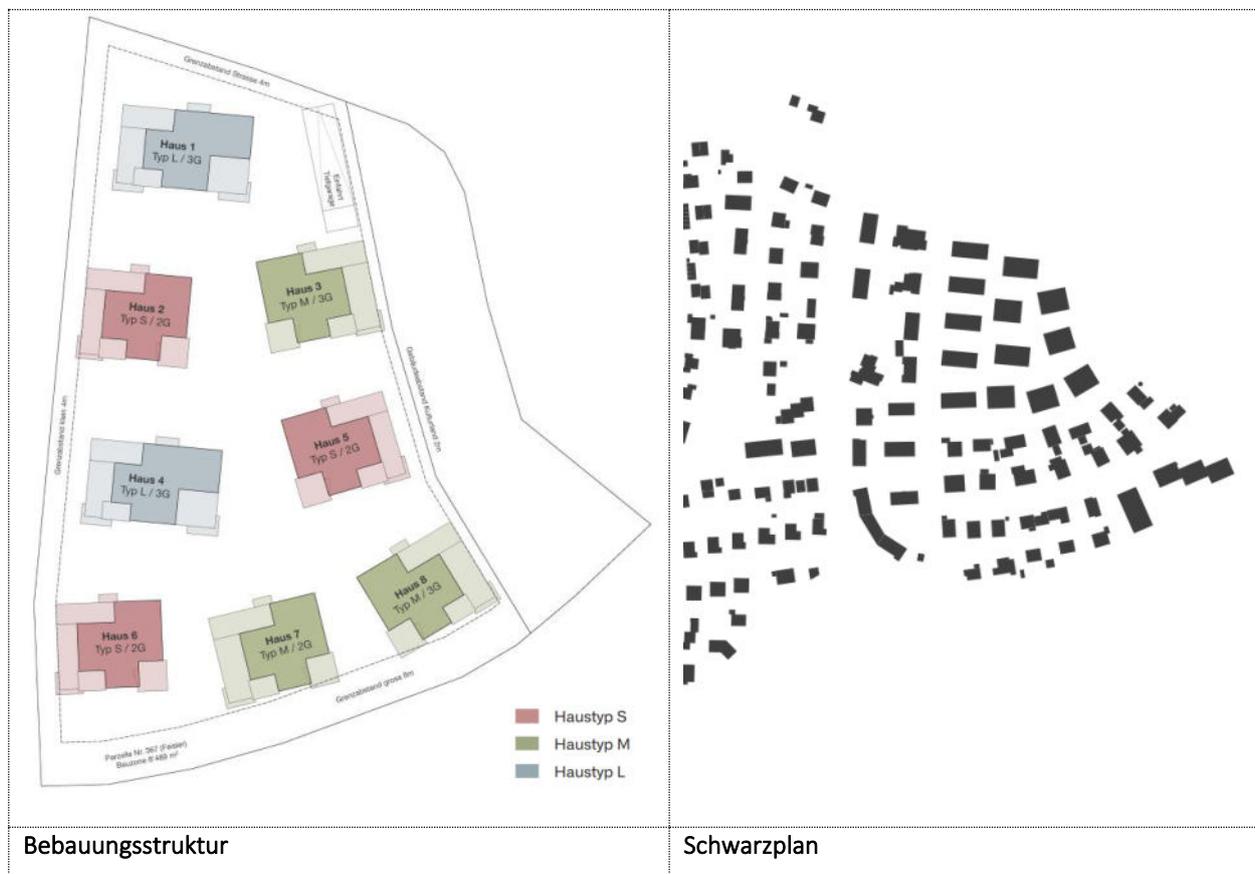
Richtprojekt Bebauung, Bebauungsstruktur und Schwarzplan (Menzi Bürgler Kuithan)
